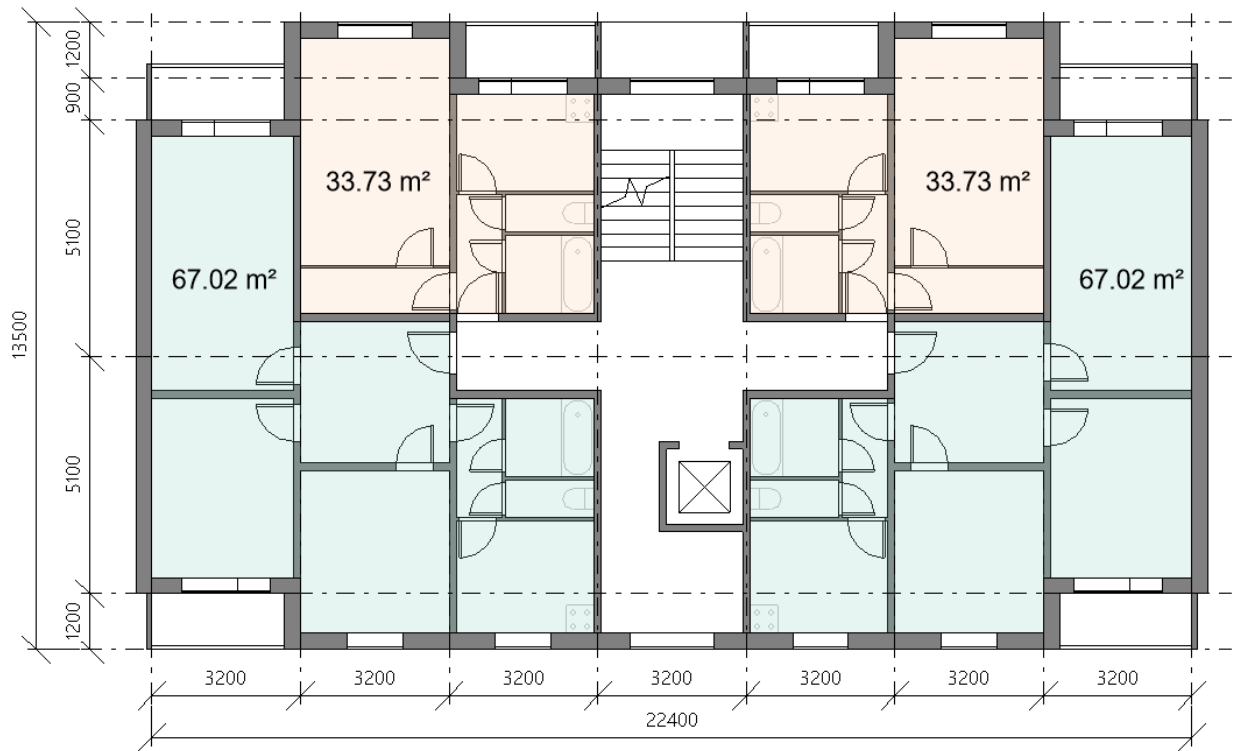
Рядова секція будинку 2-2-3-3.
